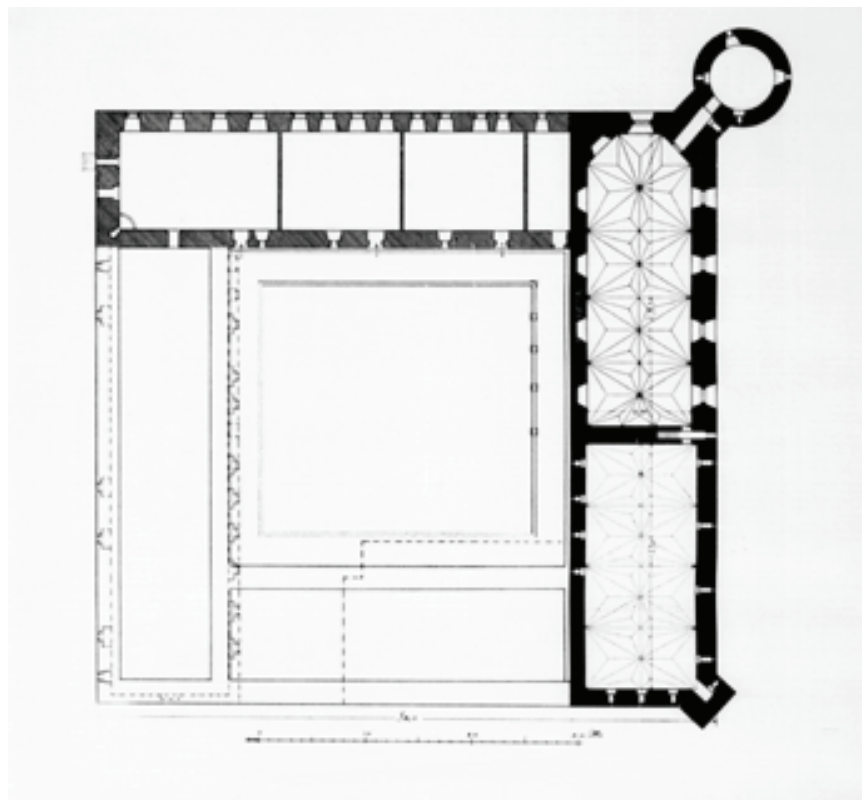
Burg Barten, Hauptgeschoss, Grundriss nach C. Steinbrecht
